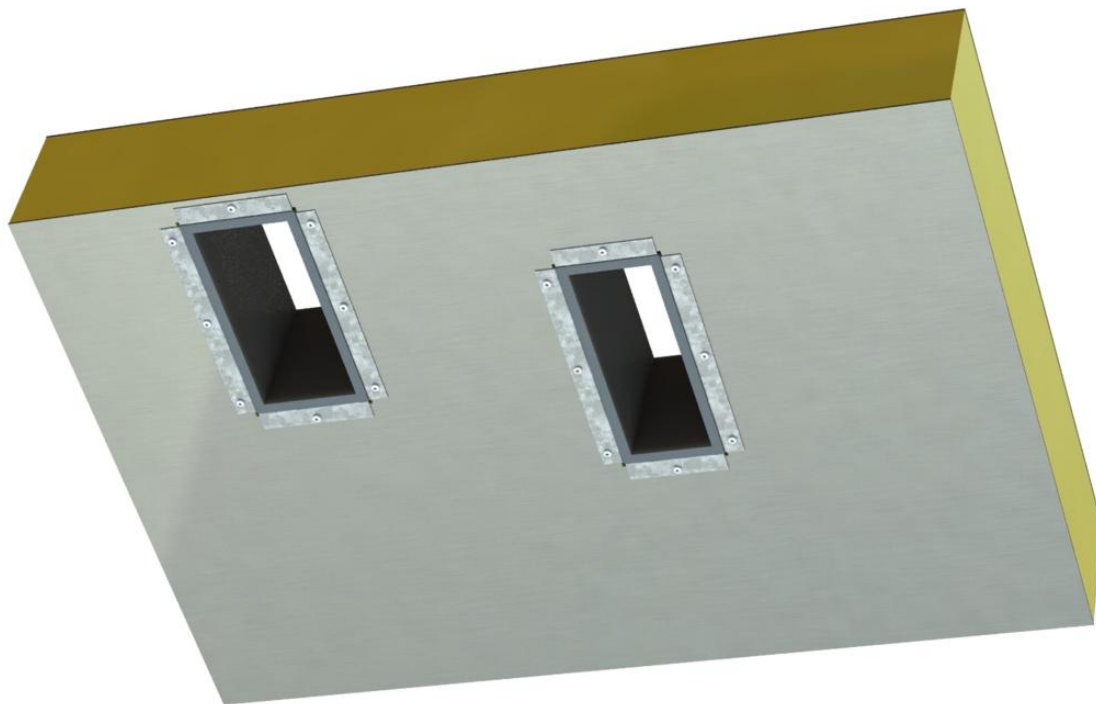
Разметка отверстий и крепление воздуховодов.
